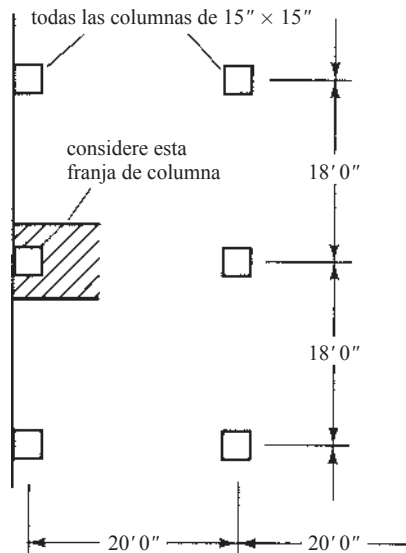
Dimensiones de la losa plana del Ejemplo 16.5.
